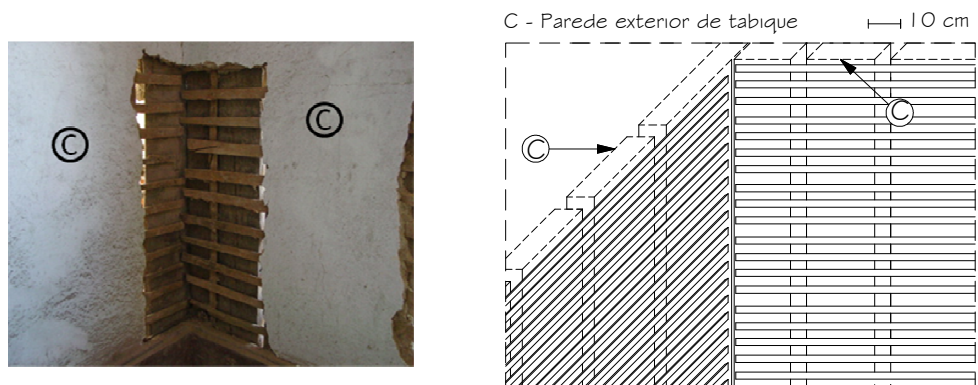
Ligação de canto entre duas paredes exteriores
